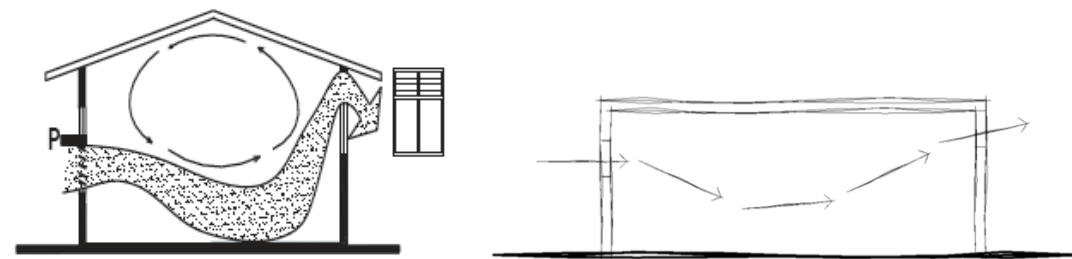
TIPO DE VENTILACIÓN UTILIZADO.
